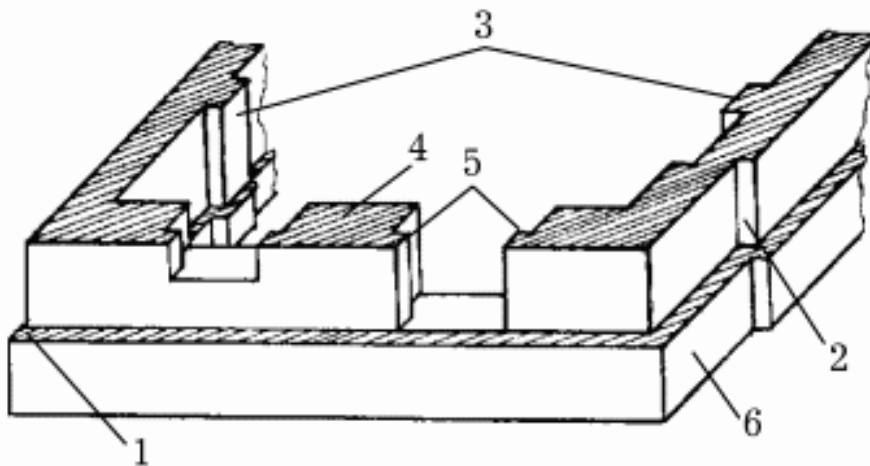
Детали каменных конструкций: 1 – обрез; 2 – уступ кладки; 3 – пилястры; 4 – простенок; 5 – четверть; 6 – цоколь.
